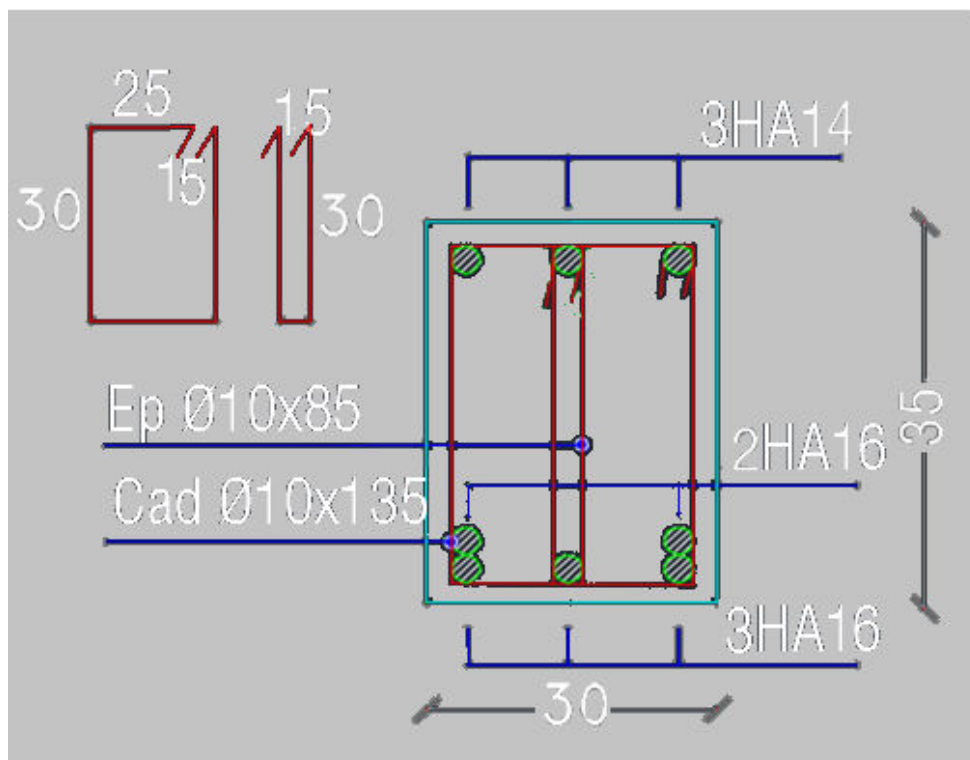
Ferrailage des poutres secondaires au niveau d'appuis de niveaux 8<sup>ème</sup> à 13<sup>ème</sup> étage.
